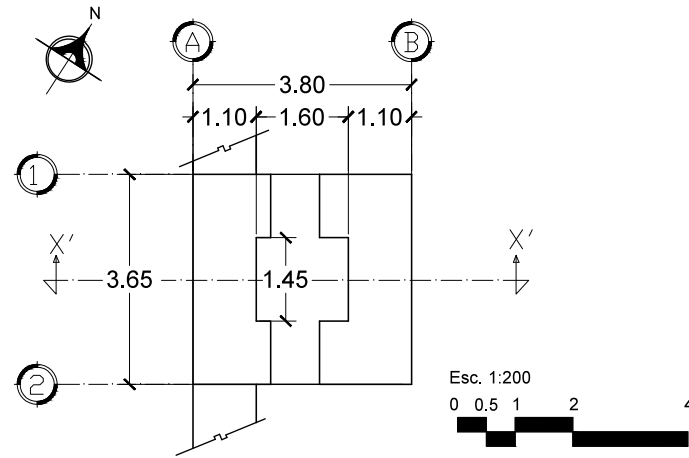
Planta arquitectónica y sección por tramo del chacuaco Cuahuixtla
